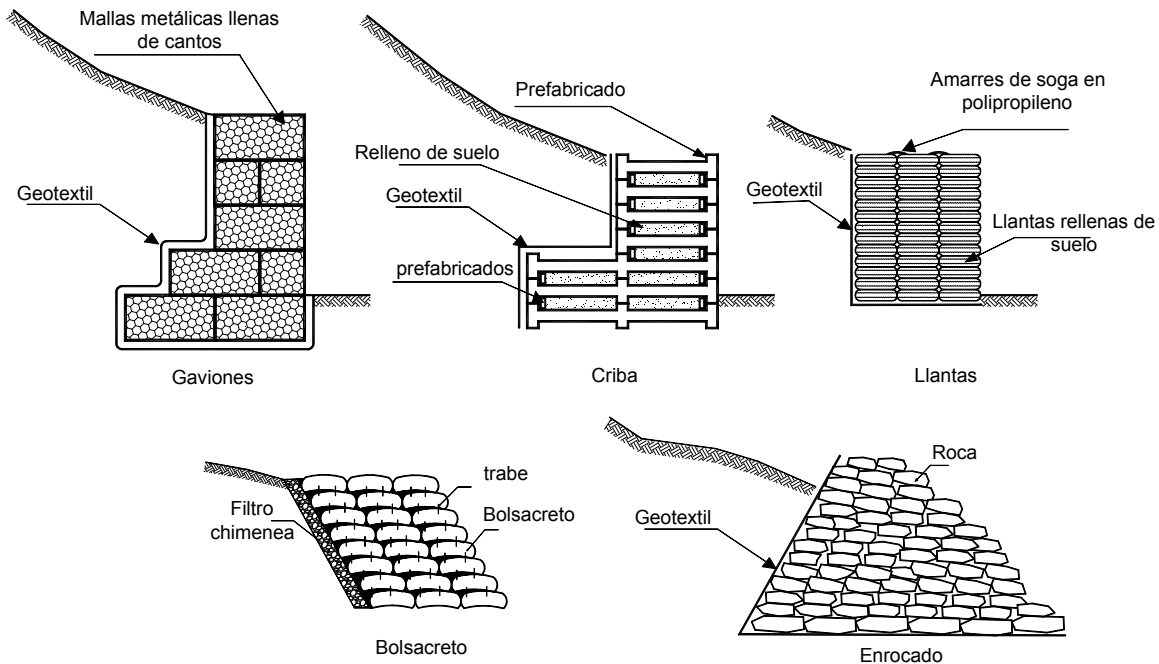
Esquemas de algunos tipos de muros flexibles.
